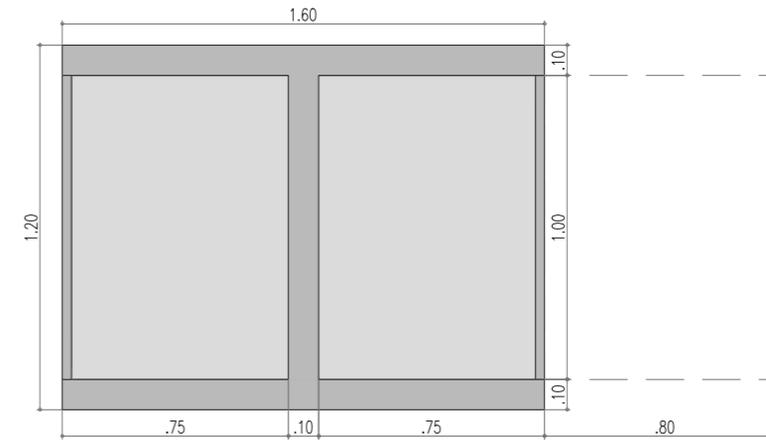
Planta puesto de venta estacionario tipo 2. Esc 1:25
